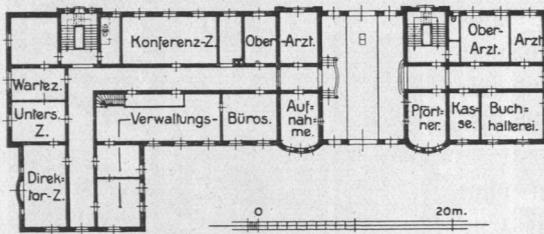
Irrenanstalt Friedrichsberg, Verwaltungsgebäude, Erdgeschoss, Grundriß.
